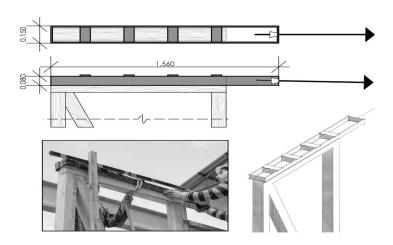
DETALLE DE PLATINA, FUENTE: AUTOR
